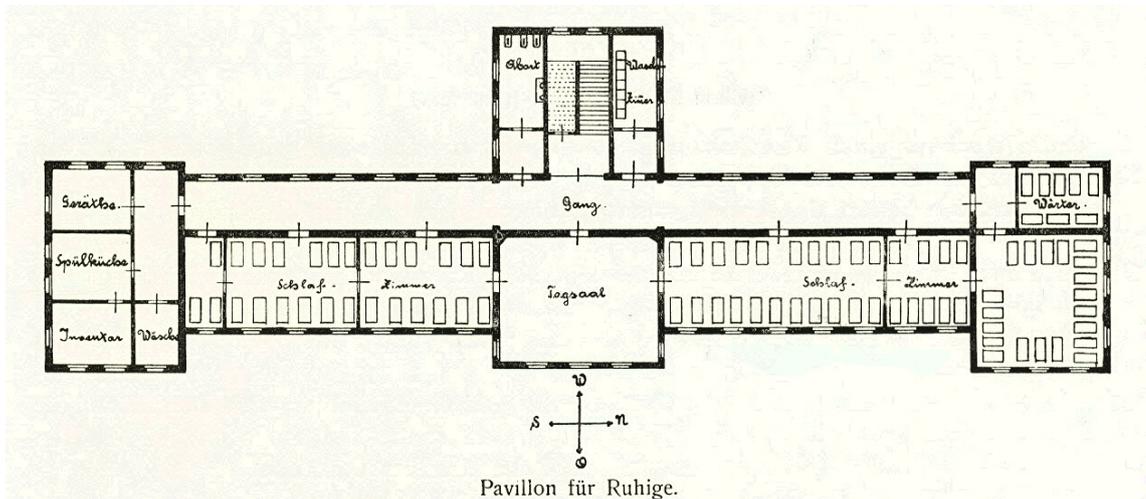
PAVILLONGRUNDRISS IN DOBRAN
